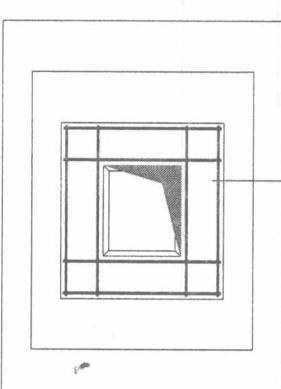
单杯口独立基础顶部焊接钢筋网示意
